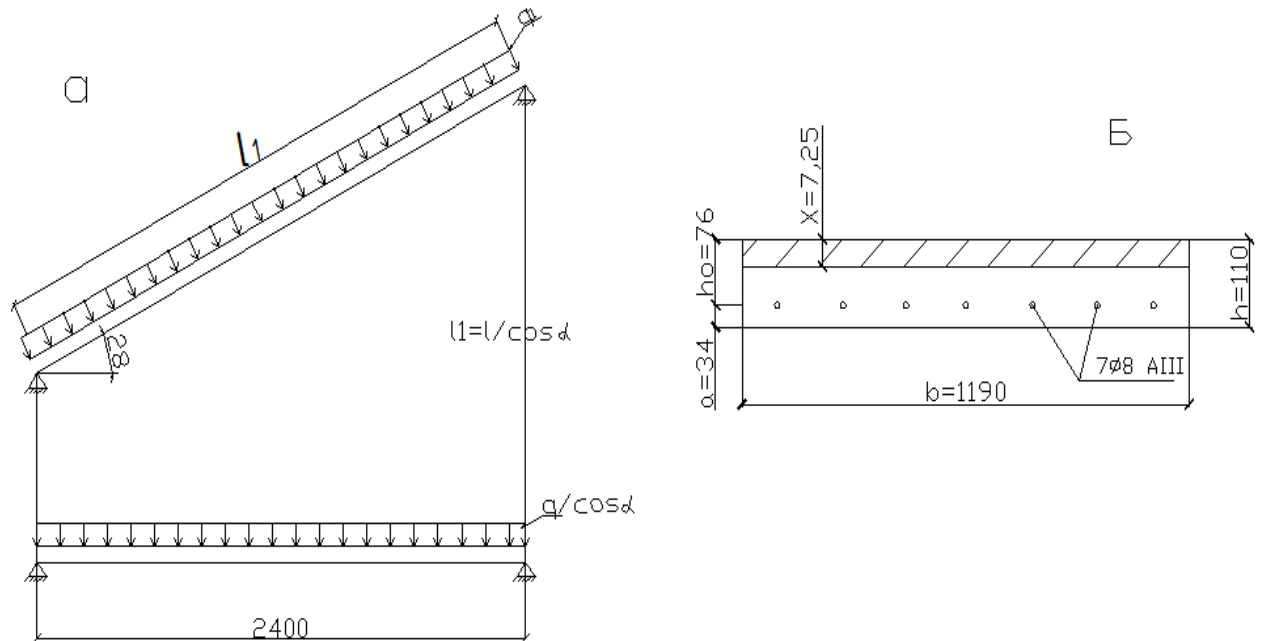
(а- расчетная схема , б – поперечное сечение марша)
